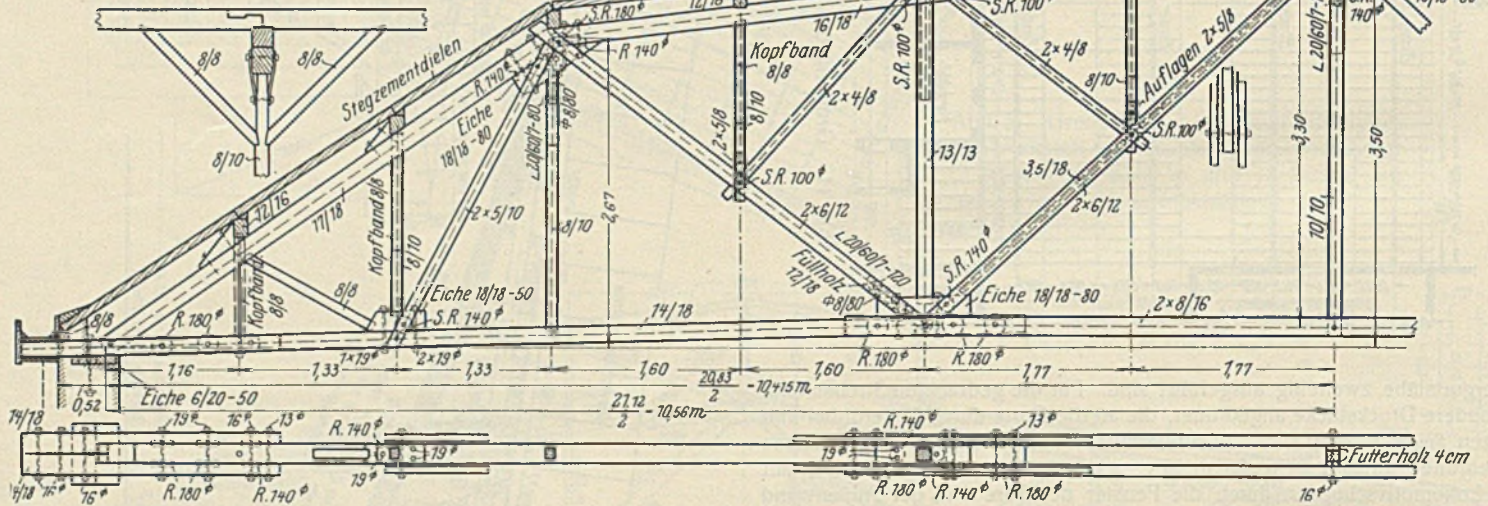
Dachkonstruktion einer Fabrikhalle von 21,12 m Stützweite.
